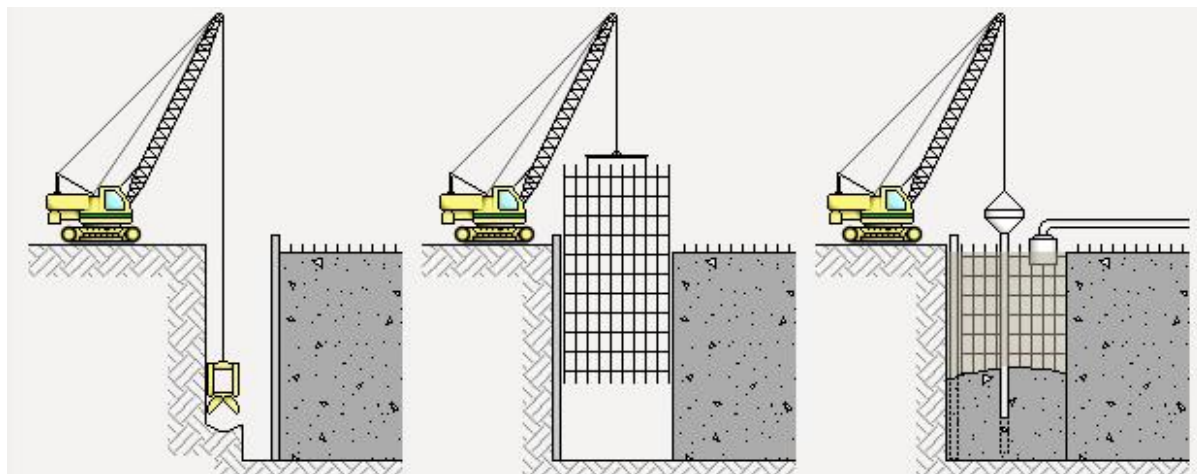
Proceso ejecución muro pantalla de hormigón armado in situ con lodos
